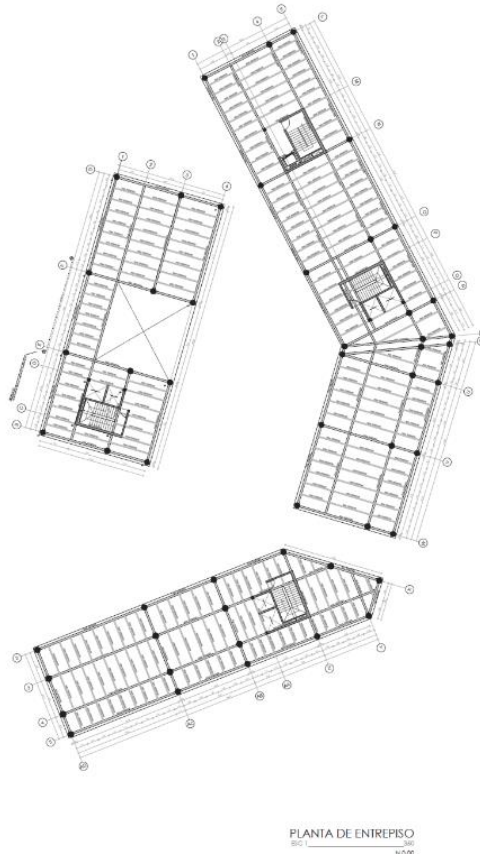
Planta de entrepiso. (Villegas, C. 2021).
